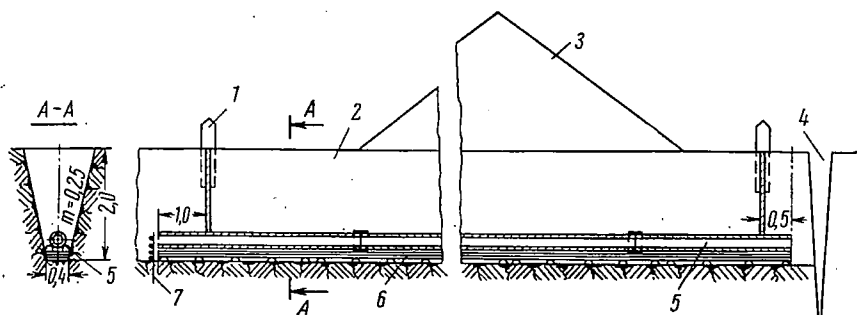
Схема моста-переезда с бетонными безраструбными трубами:
